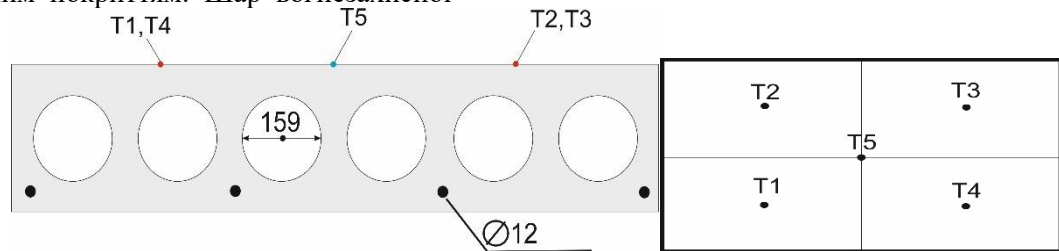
Схема розташування термопар з необігрівної поверхні залізобетонного багатопустотного перекриття при випробуванні на вогнестійкість: а – поперечний переріз, що проходить через термопари T1-T2; б – вид зверху.
